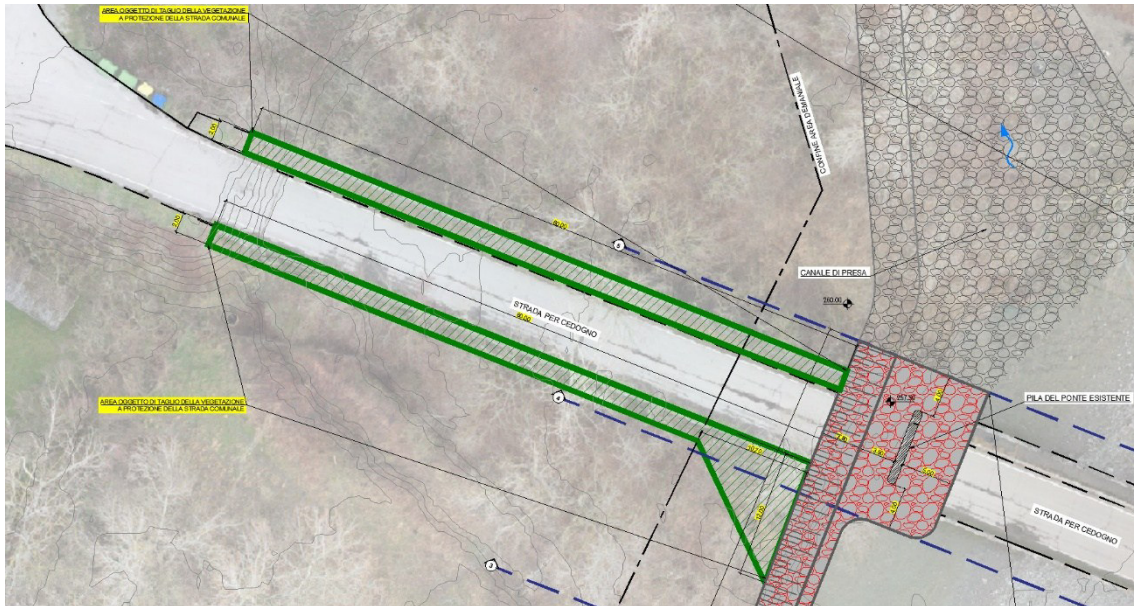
Stralcio planimetrico con indicate in verde le aree di taglio della vegetazione
